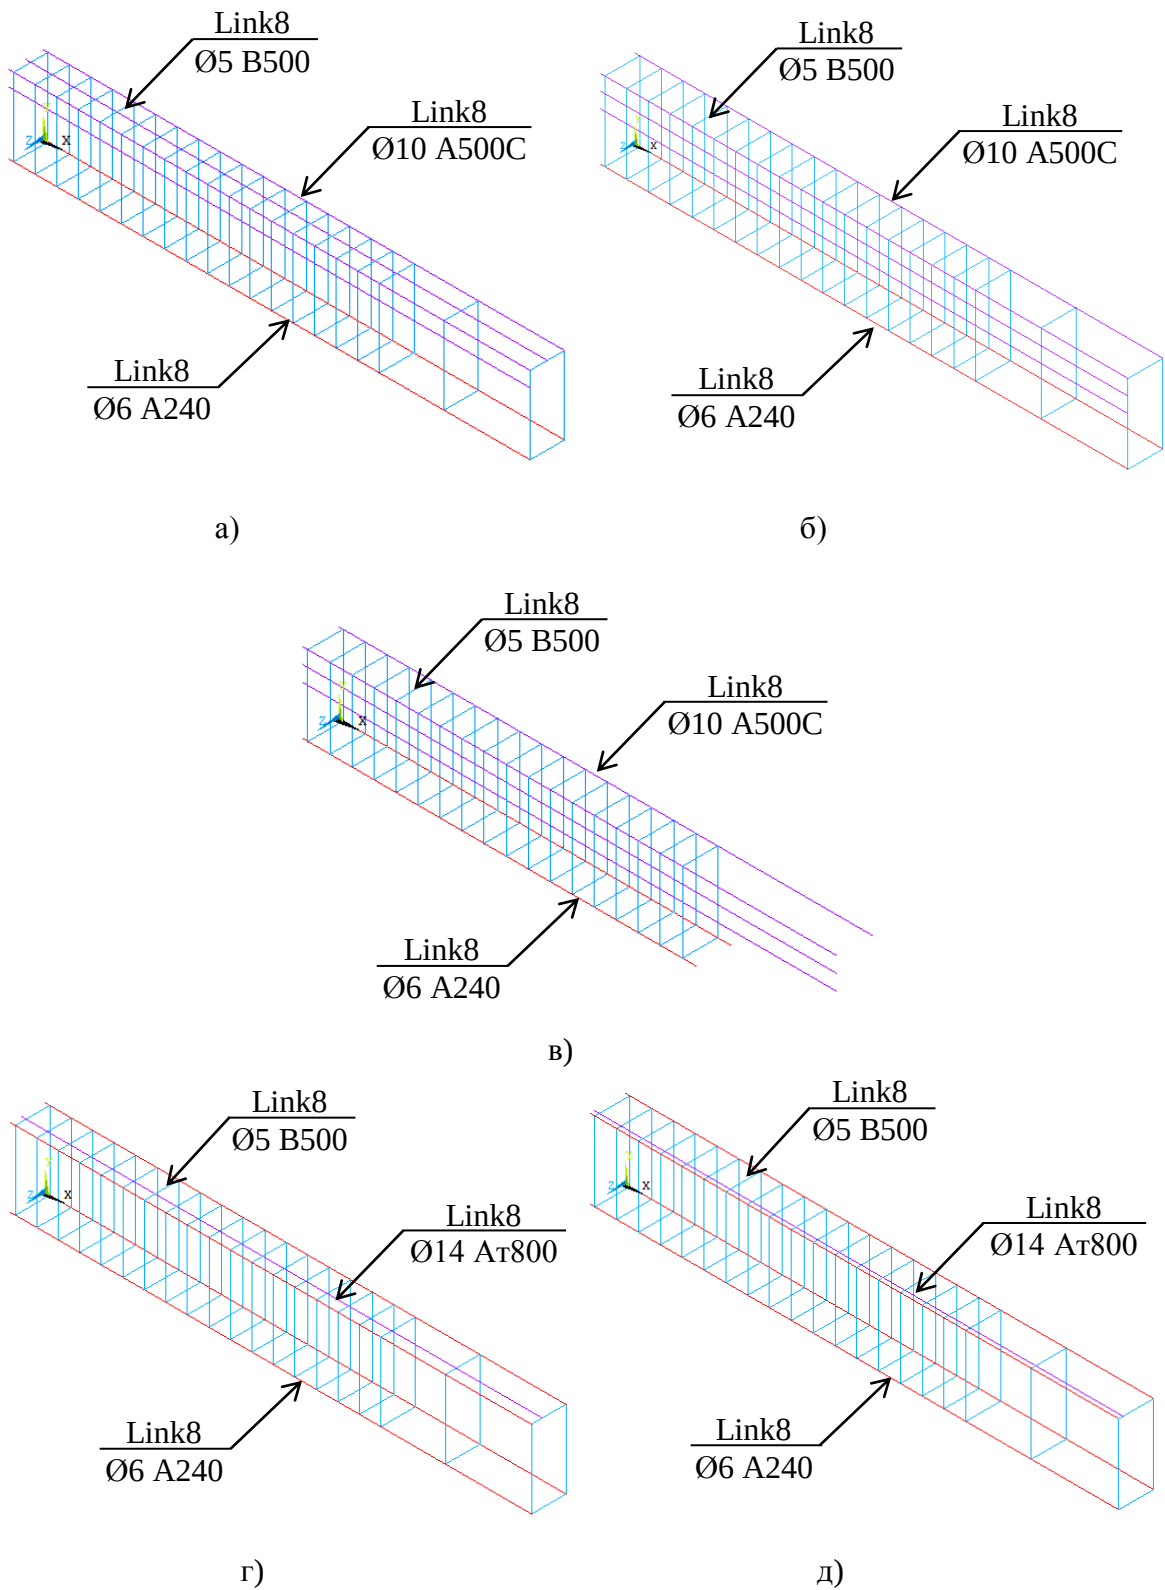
Общий вид арматурного каркаса балок серий: а) ЖБ1, ФЖБ1.1; б) ЖБ2, ФЖБ1.2; в) ФЖБ1.3; г) ФЖБ2.1; д) ФЖБ2.2
